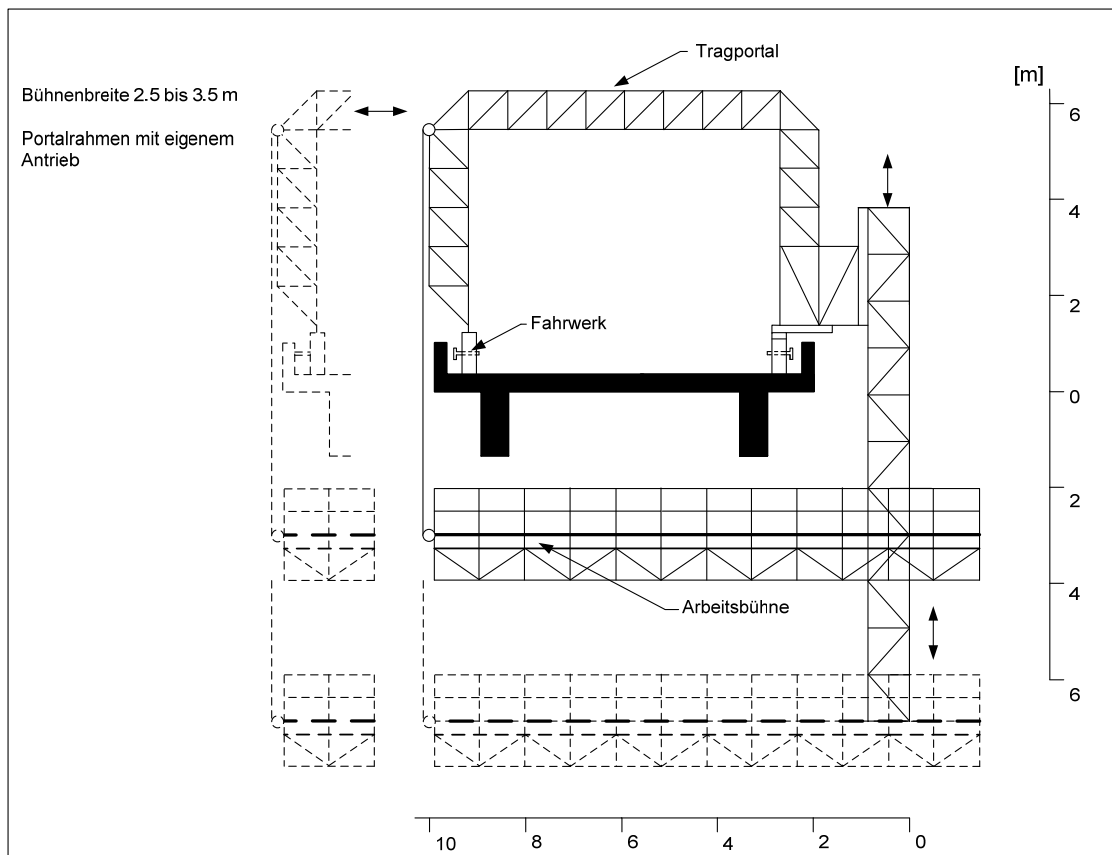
Fahrbare Portalarbeitsbühne, Schemazeichnung
